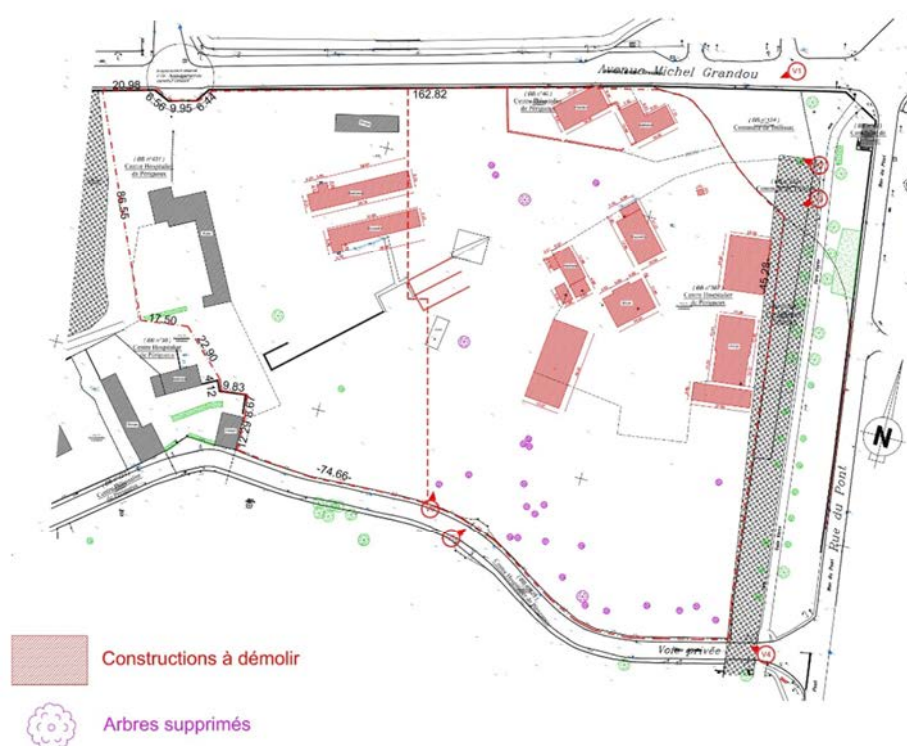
Constructions à démolir sur site (Source : Extrait du Permis de Construire ; août 2019)
